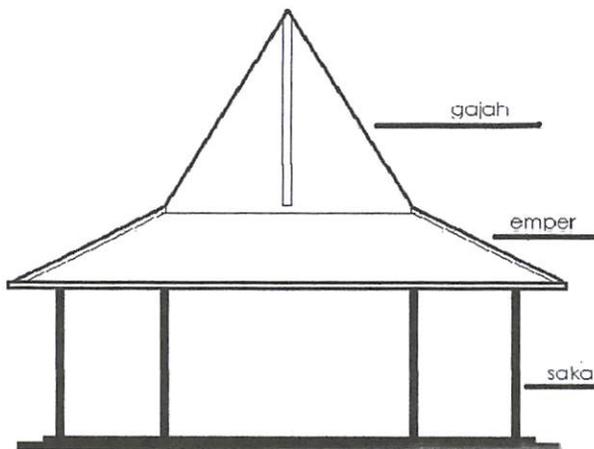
Tampak samping bangunan tipe limasan
